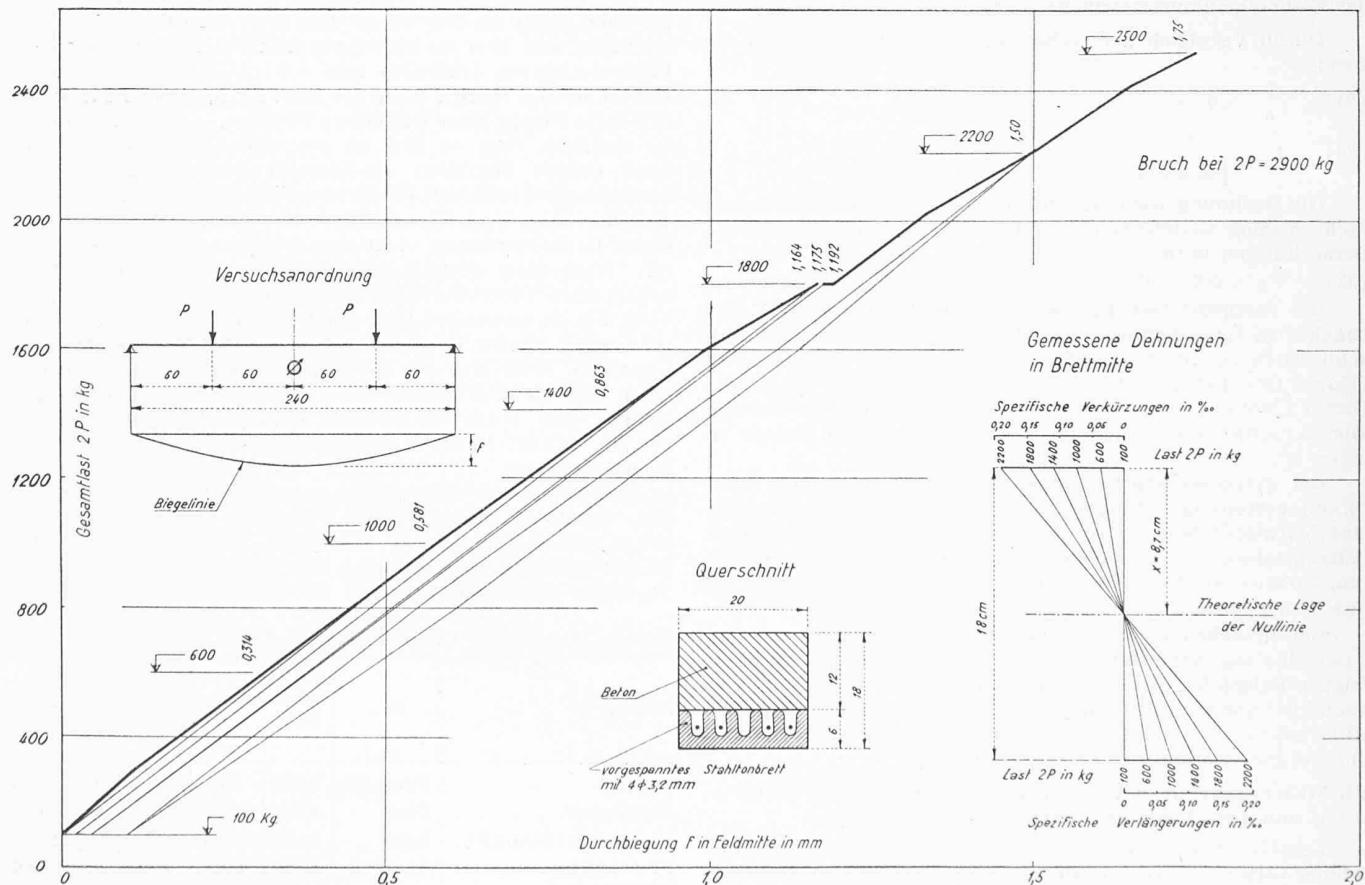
Durchbiegungen und Dehnungen in vorgespanntem Stahltonbrett mit Ueberbeton
